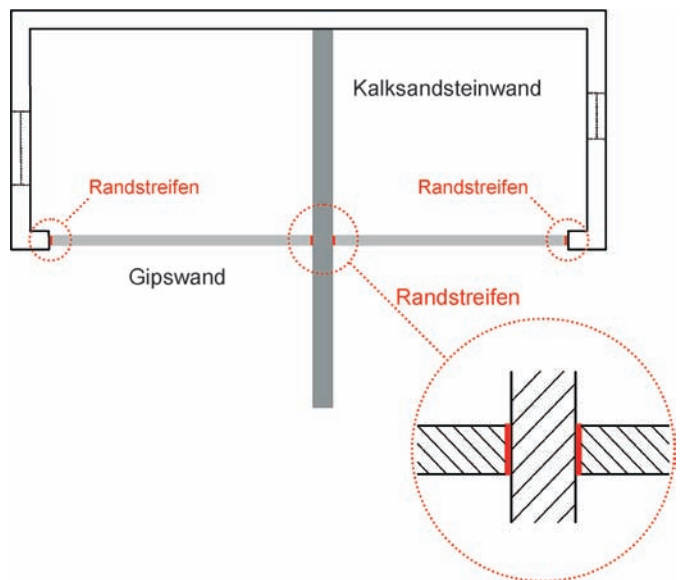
Schematische Darstellung (Grundriss) des Flankenprüfstands mit Kalksandsteinwand und flankierenden Gipswänden
